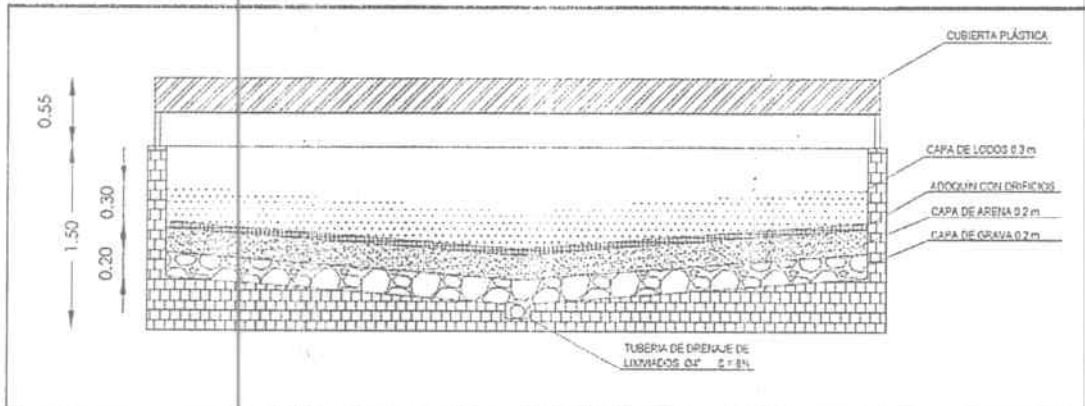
Lecho de secado de lodos - vista frontal.
